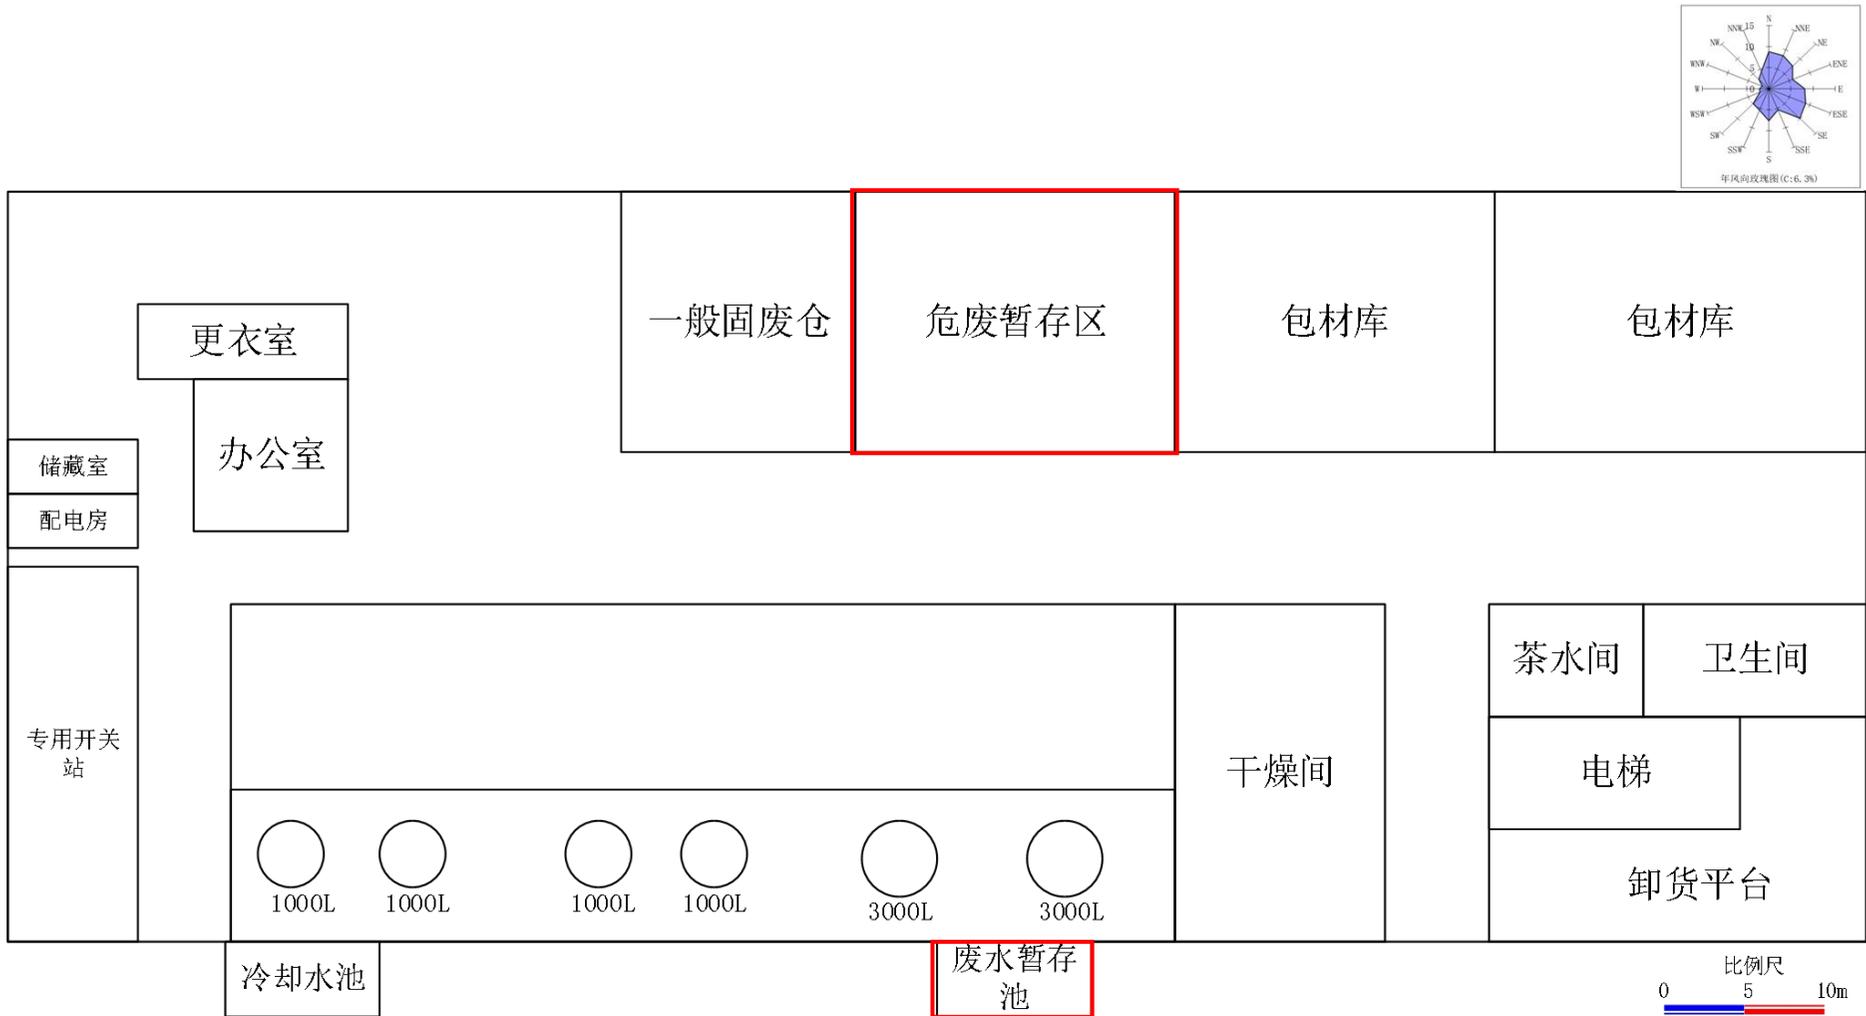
生产车间一（金银花干粉生产车间）平面布置图
